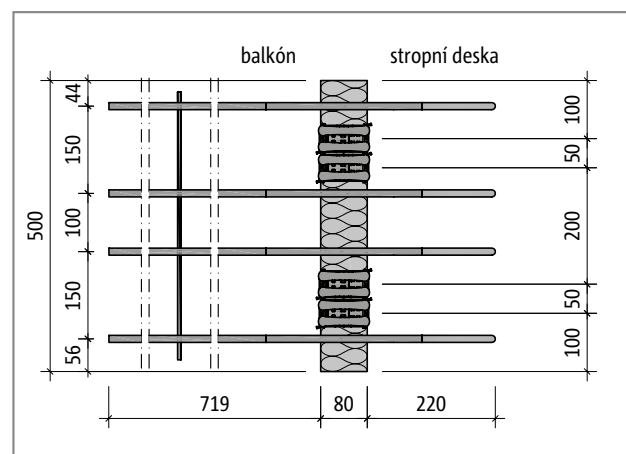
Schöck Isokorb® typ Q10S: Půdorys prvku
